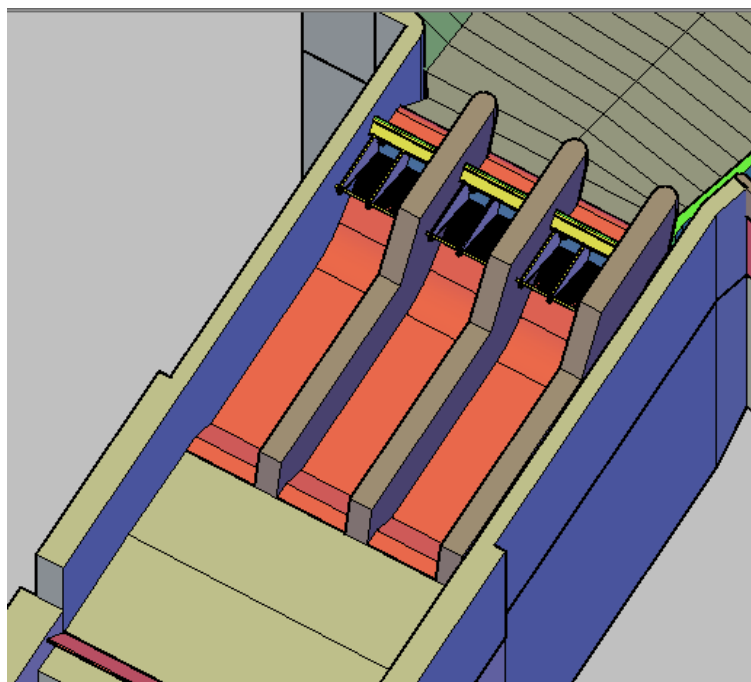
VISTA DE LA ESTRUCTURA DE CIERRE
